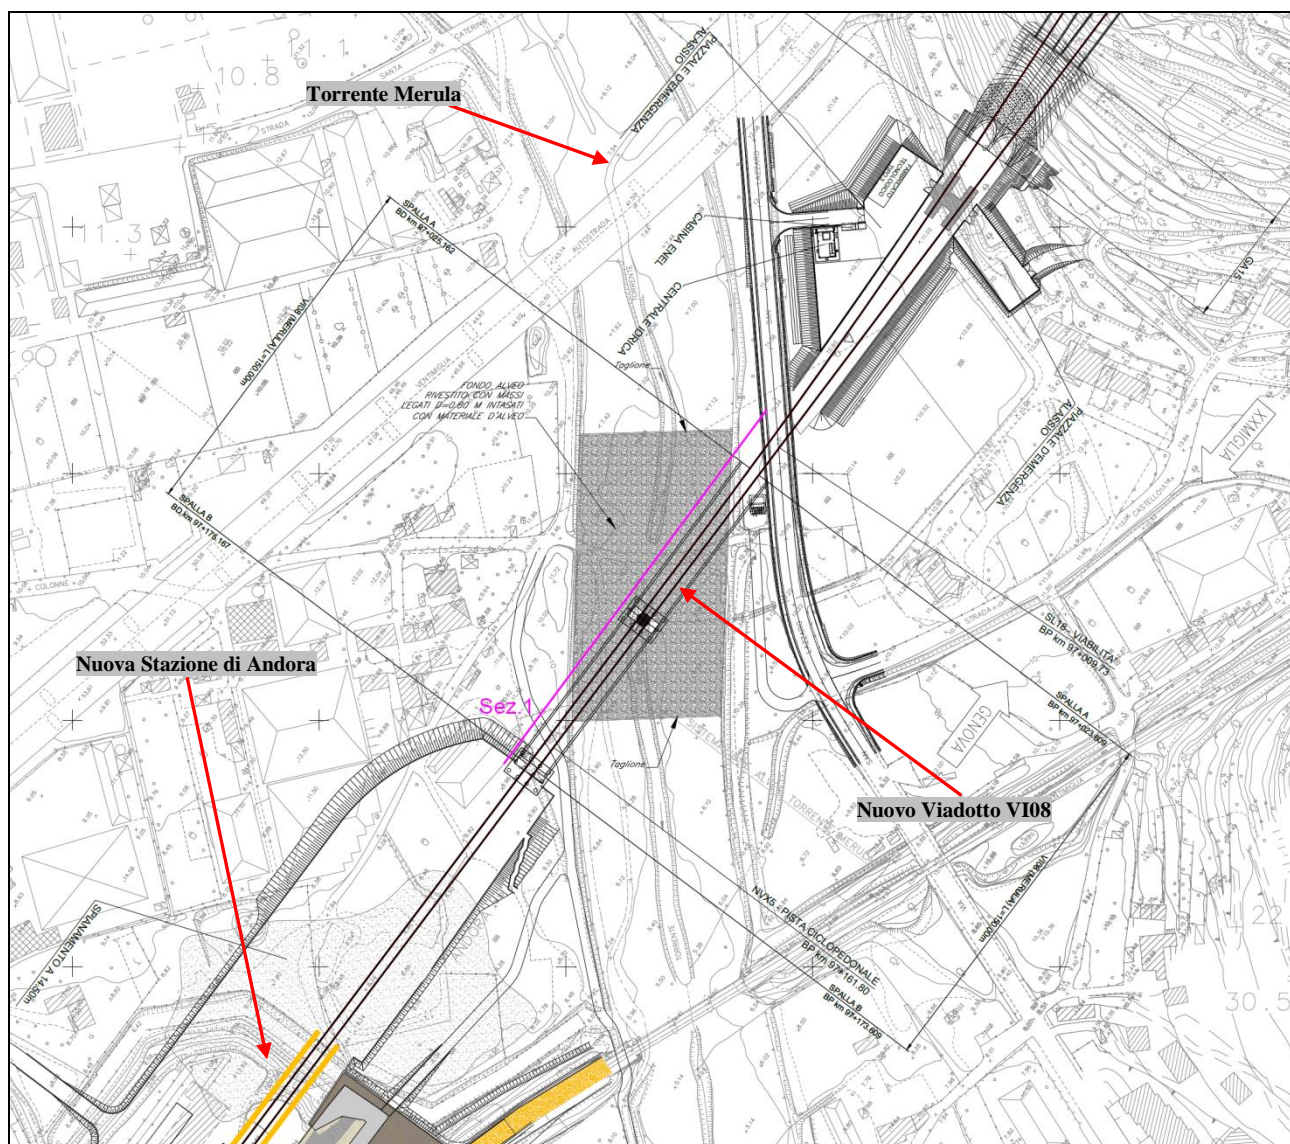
Stralcio della planimetrica di progetto in quel di Andora
